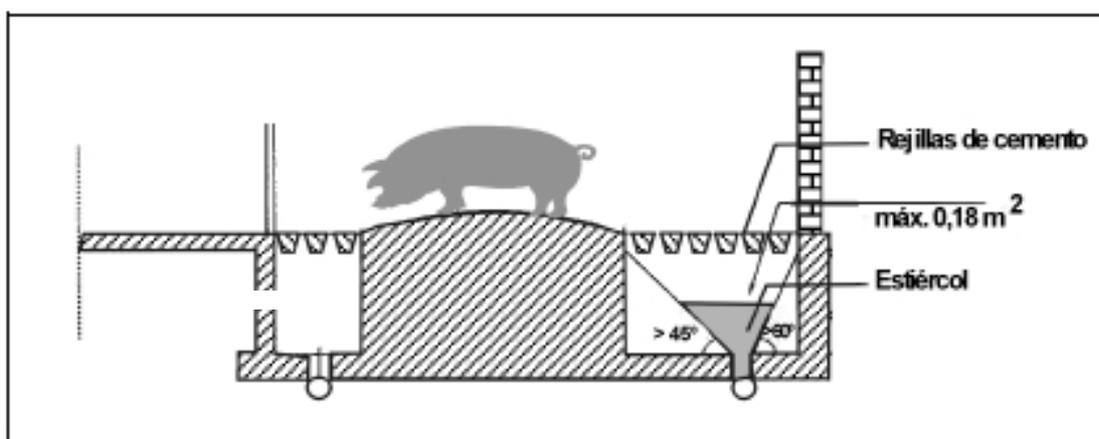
Suelo convexo con rejillas de cemento y paredes laterales inclinadas en el canal estercolero
